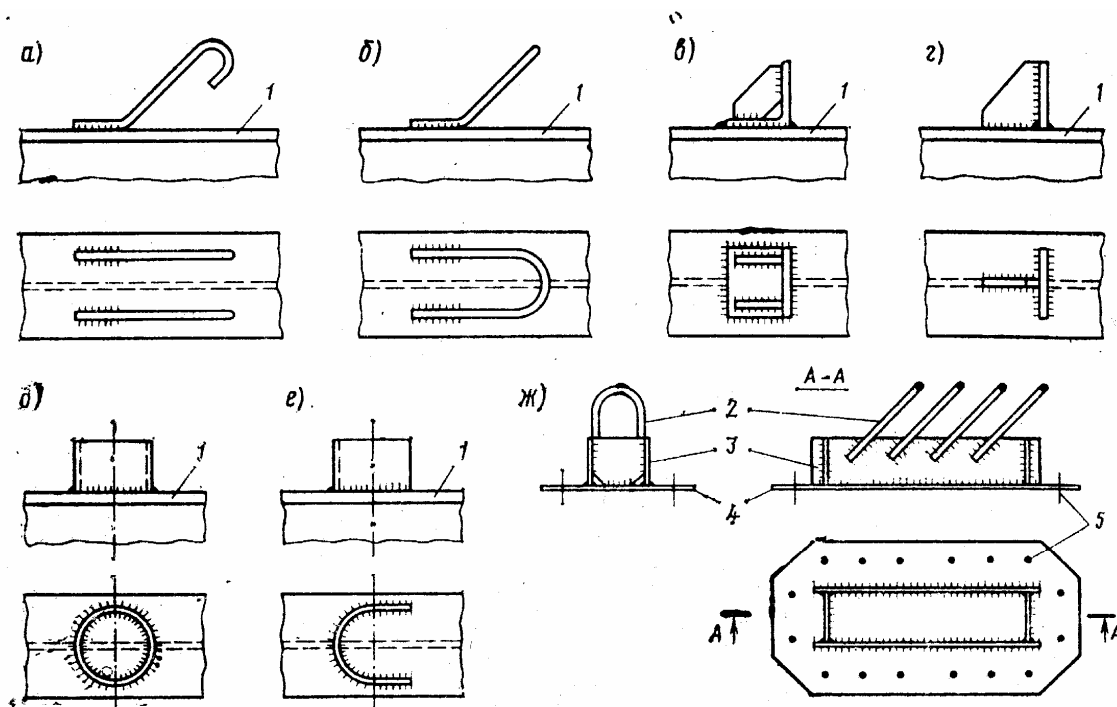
Анкеры и упоры для прикрепления железобетонной плиты к стальной балке
